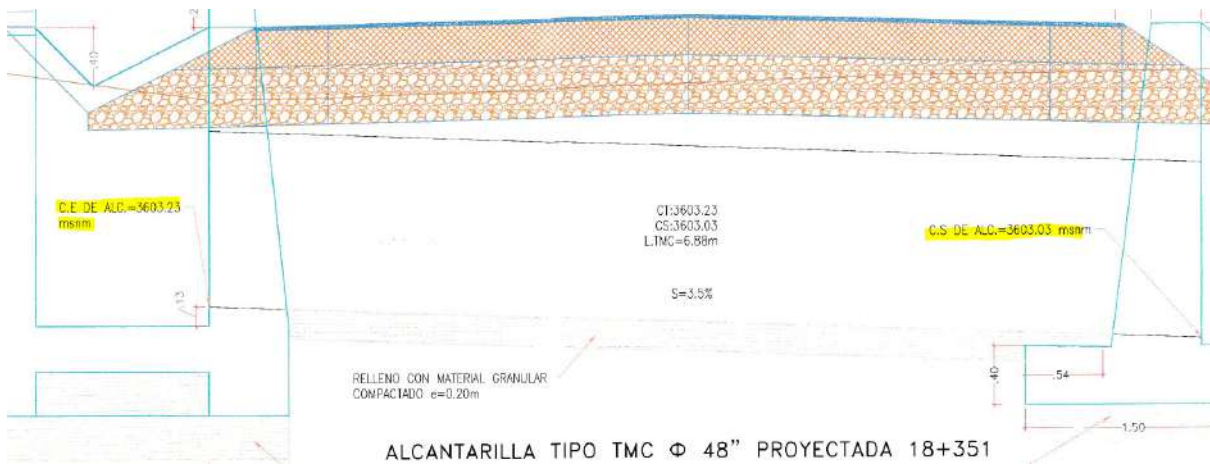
Ubicación de la alcantarilla proyectada 18+351 en el plano del expediente técnico.
